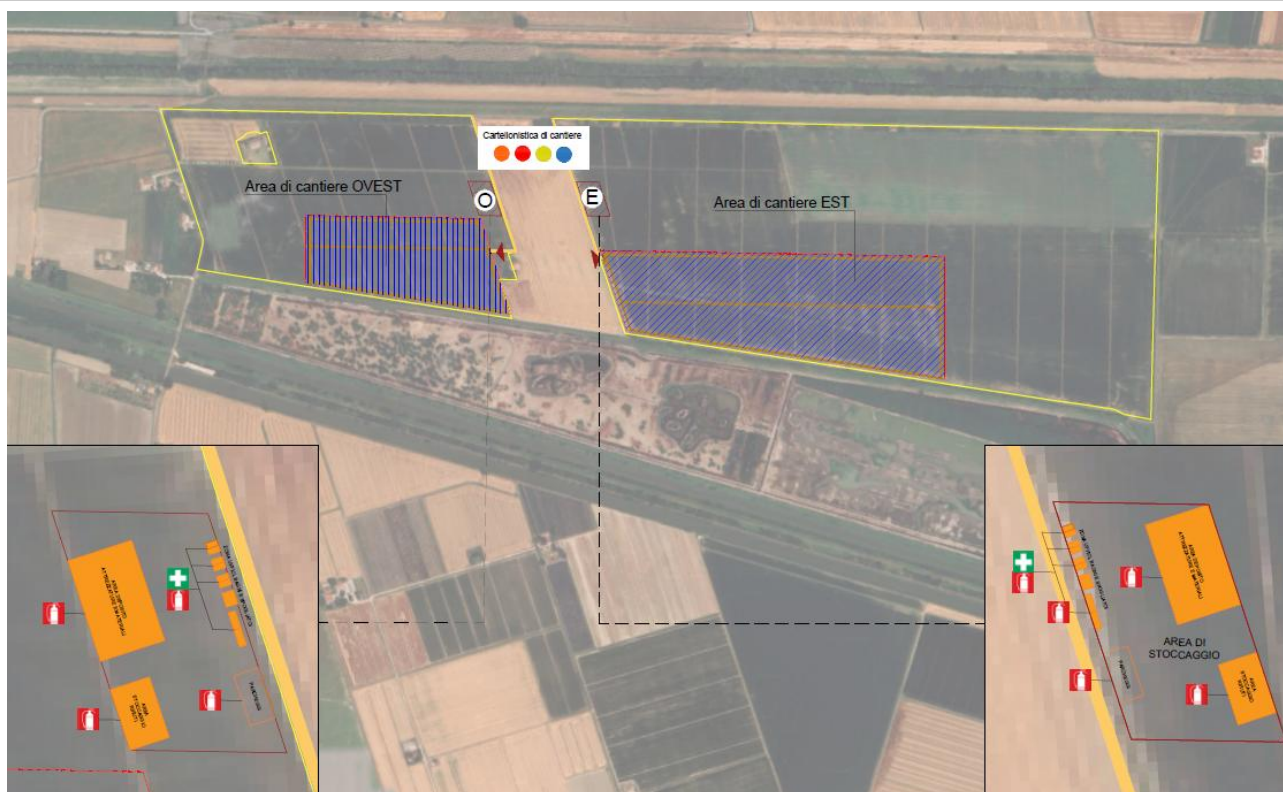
Planimetria del Piano Cantierizzazione (rif. Tav. FL_MOL_G.13)
